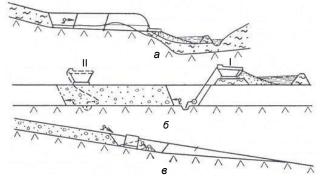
Схема вскрытия россыпи при гидравлическом способе разработки:
